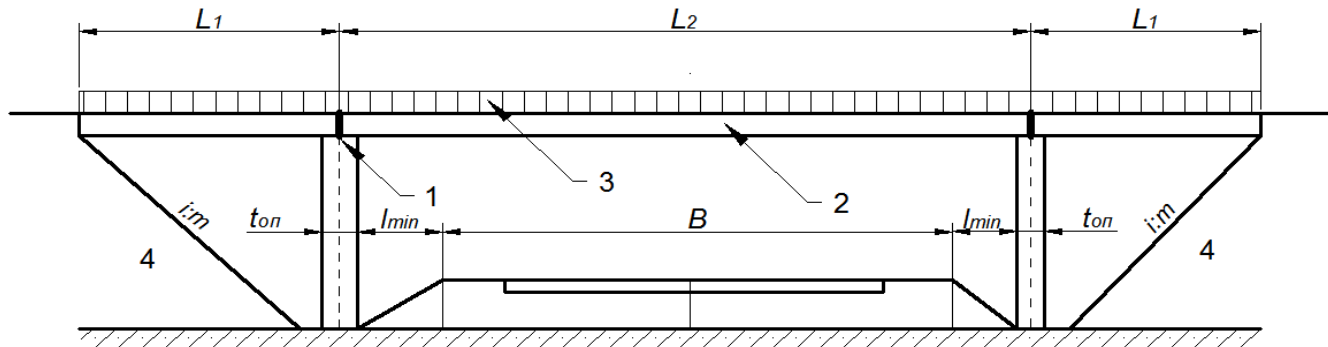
Схема трехпролетного балочного путепровода: 1 – опора; 2 – пролетное строение; 3 – перила; 4 – конус насыпи.
